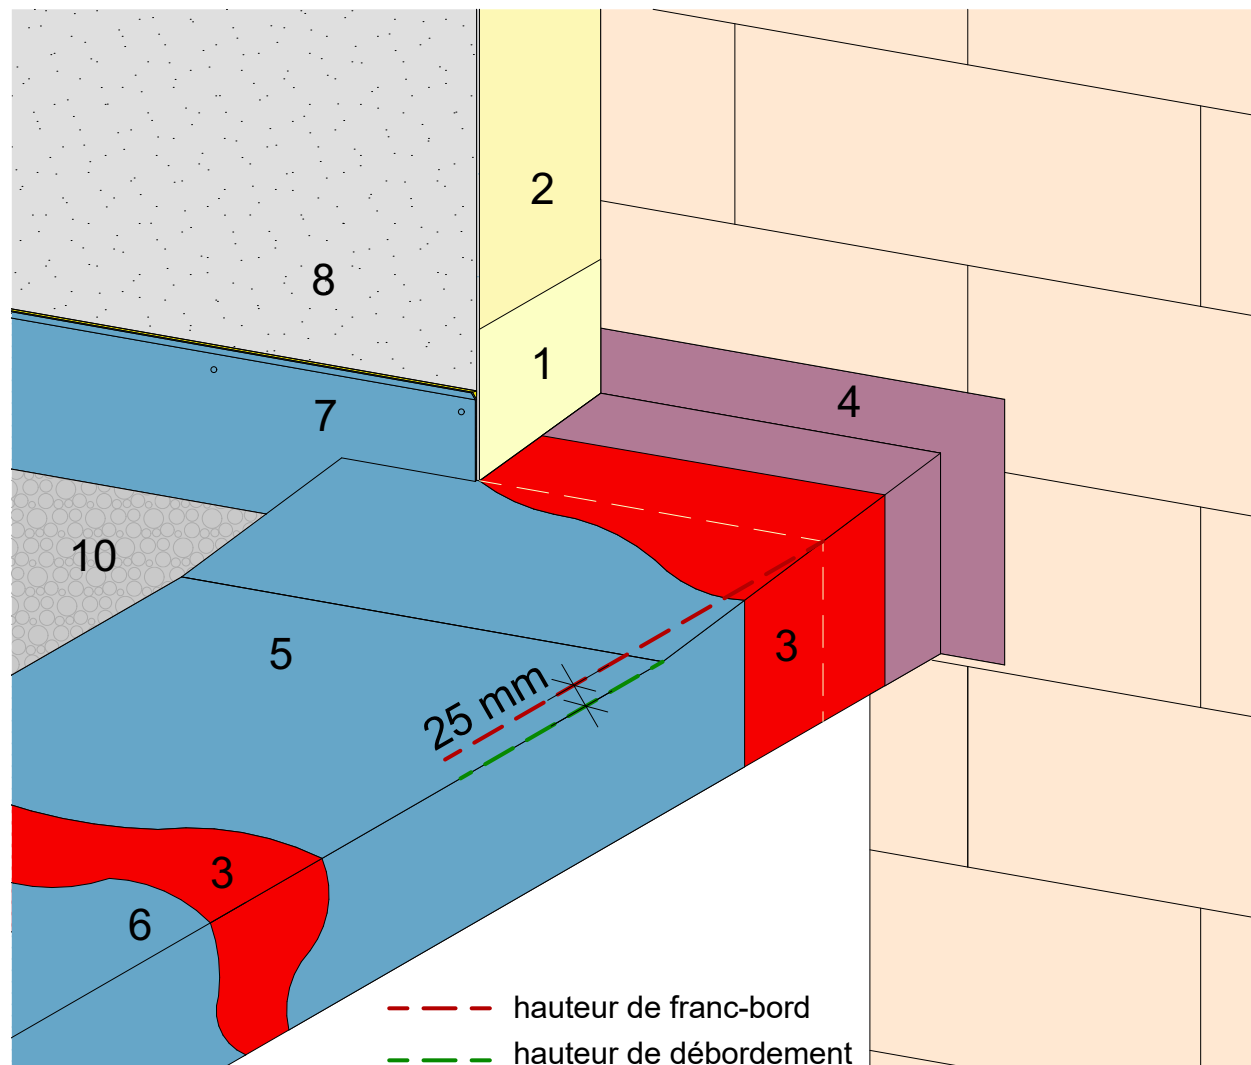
Raccordement au mur Variante 2 (exemple 1)
